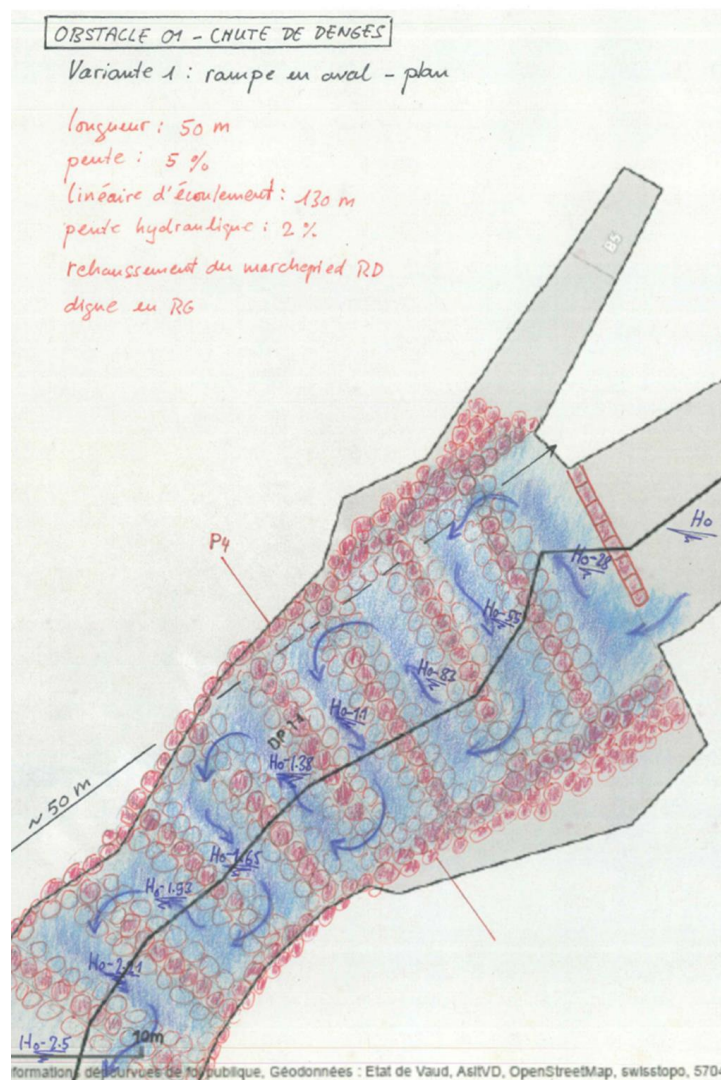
Variante 1 : rampe rugueuse à l'aval du seuil - croquis en plan
